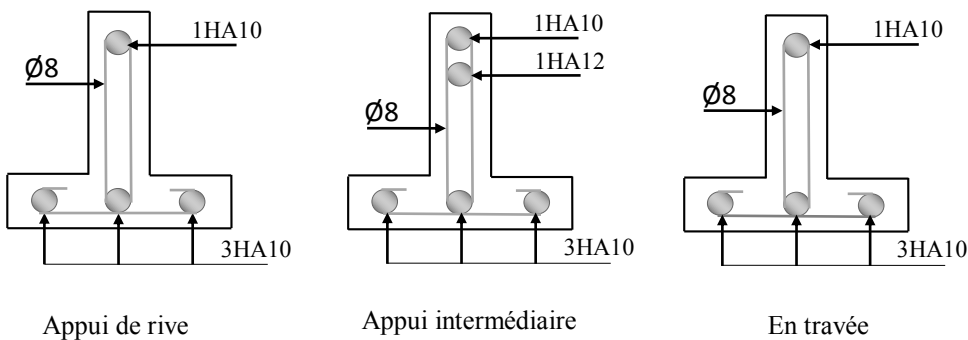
Ferrailage des poutrelles au plancher terrasse
